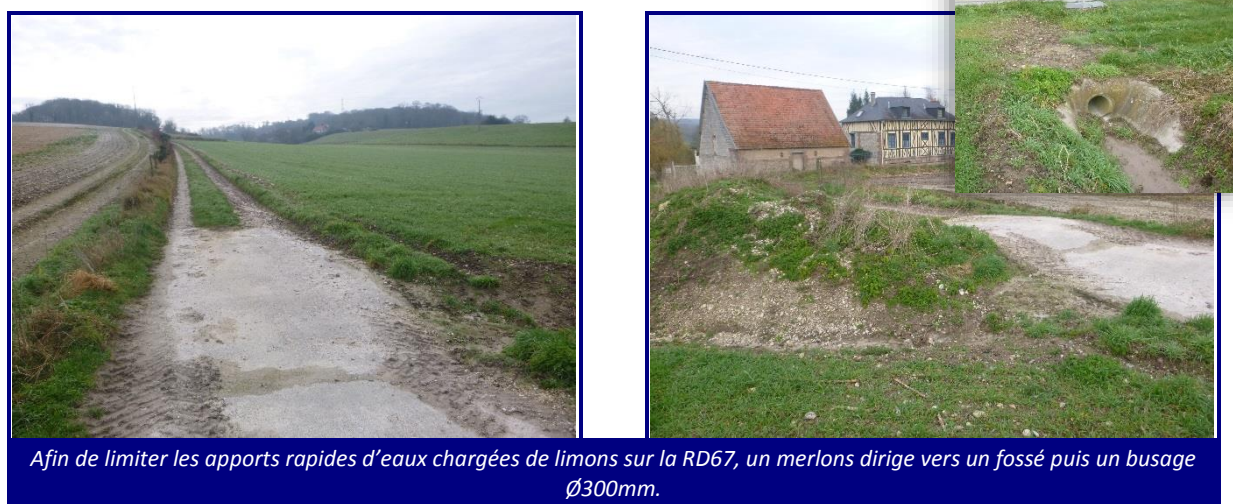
(vues a et b) : Saint Pierre de Manneville – RD67
